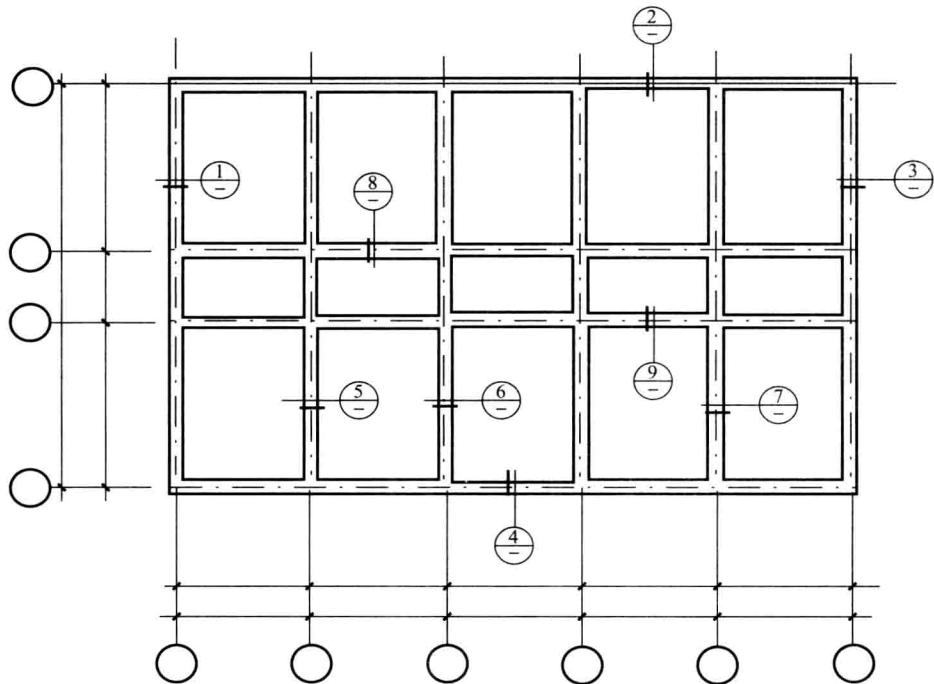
结构平面图中索引剖视详图、断面详图编号顺序表示方法
